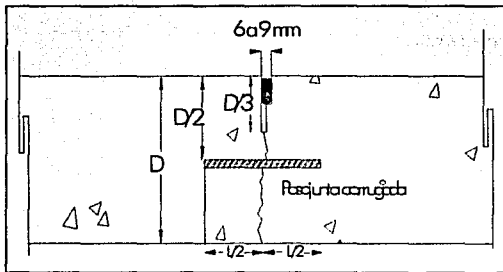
Junta longitudinal de contracción con pasajunta corrugada.
